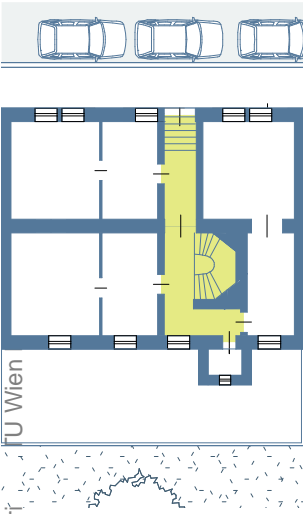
Grundriss eines Gründerzeithauses mit mittiger Erschließung im Erdgeschoß
